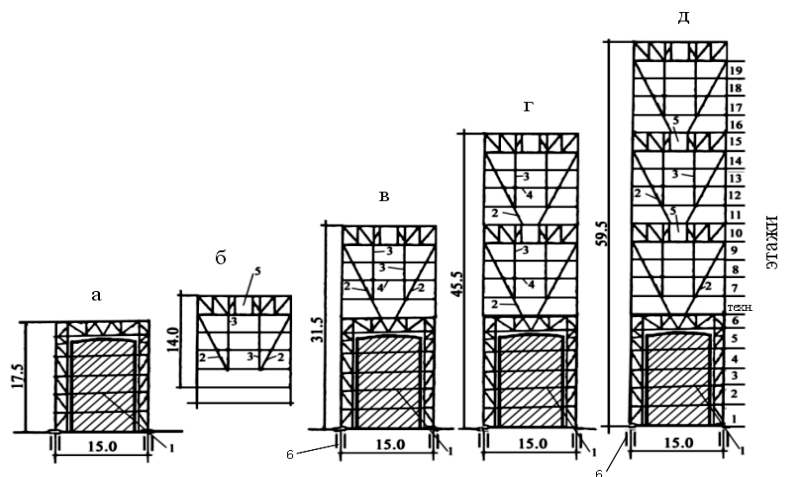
Схемы образования стального каркаса (несущих поперечных рам):
